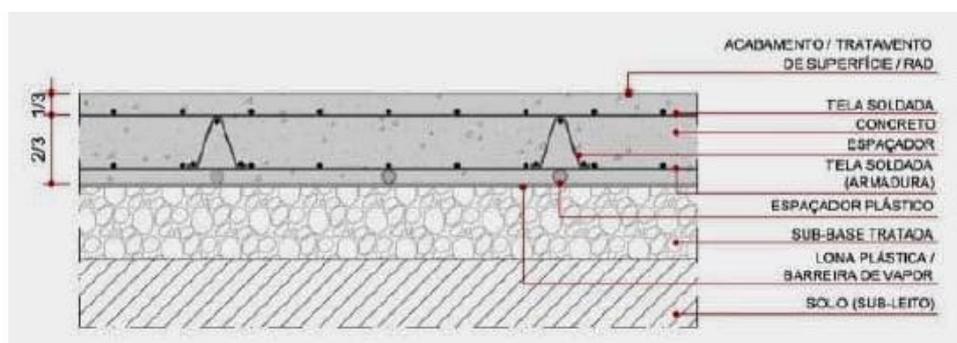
Corte esquemático da estrutura da seção tipo de pavimento rígido
